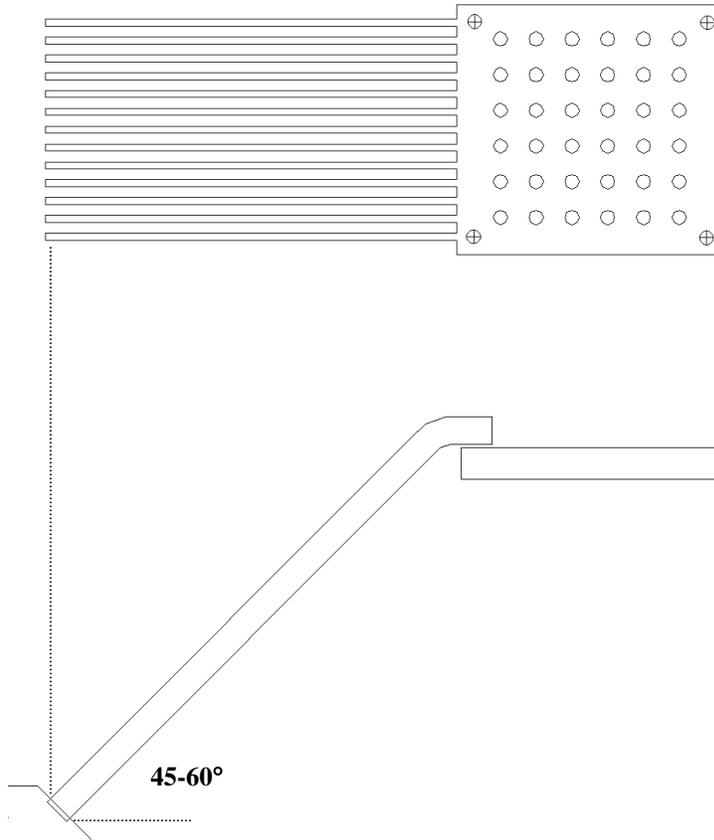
Detalle de una Rejilla de Metal con Plataforma de Drenaje.
